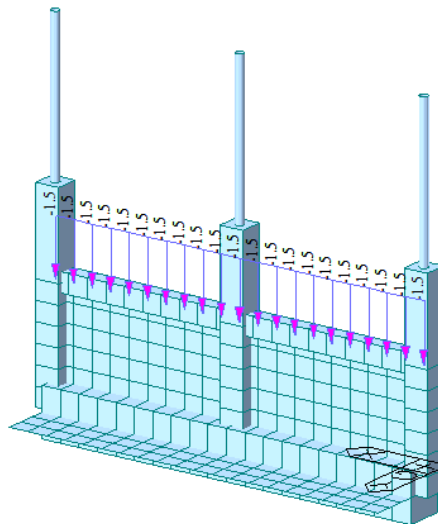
Carga muerta de mampostería no estructural. Fuente: MIDAS GEN.
